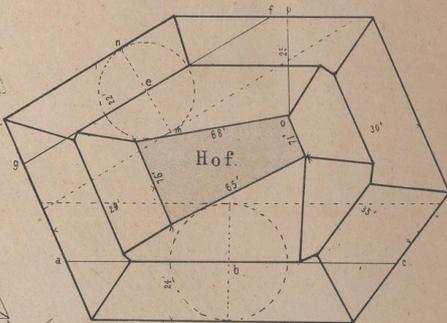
Ausmittlung verschiedener Dachformen eines Mansarden- und Böhlendaches. Satteldaches u. eines halbkreisförmigen Kegeldaches mit Plattformen, letztere zwei Dachungen mit 45° Neigung.
